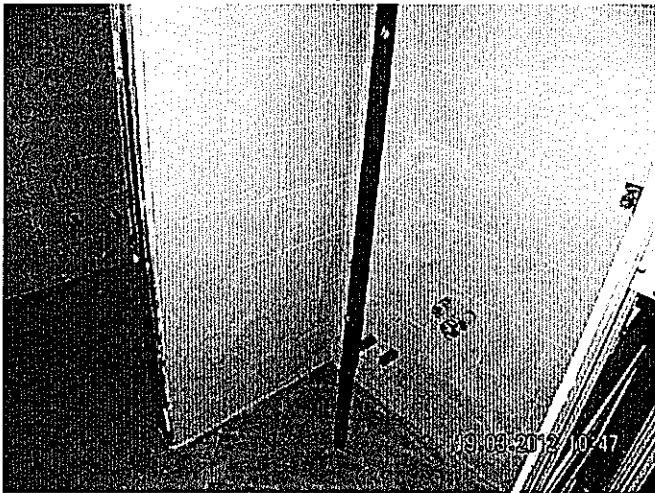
Bagno (7)- Vista interna- piastrellato ed impianti posati
